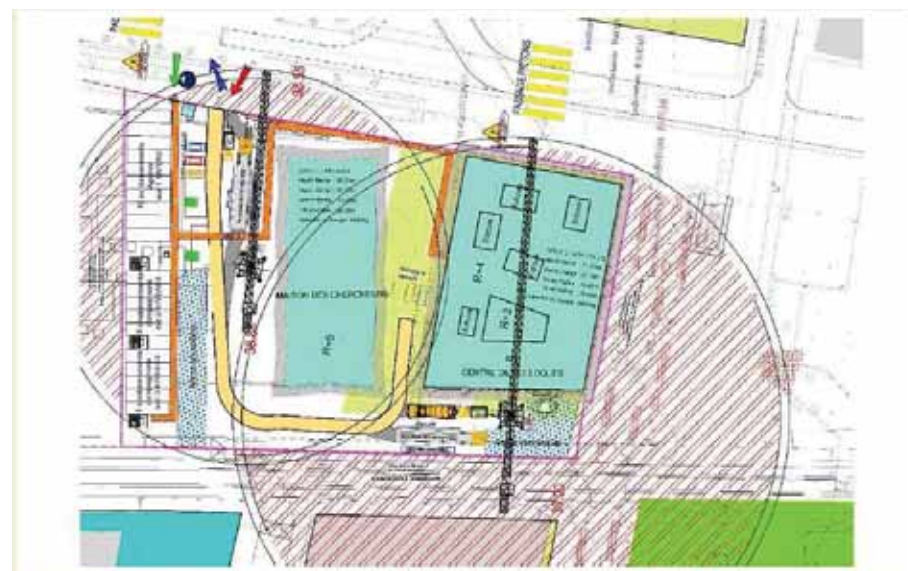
Plan du chantier îlot 3 Sud (Source : GROUPEMENT) Légende identique à la figure précédente
